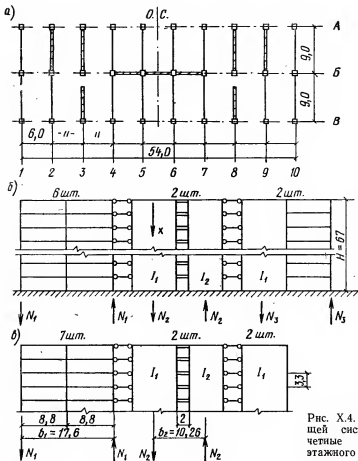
План несущей системы и расчетные схемы 20-этажного здания (к примеру расчета 8)
